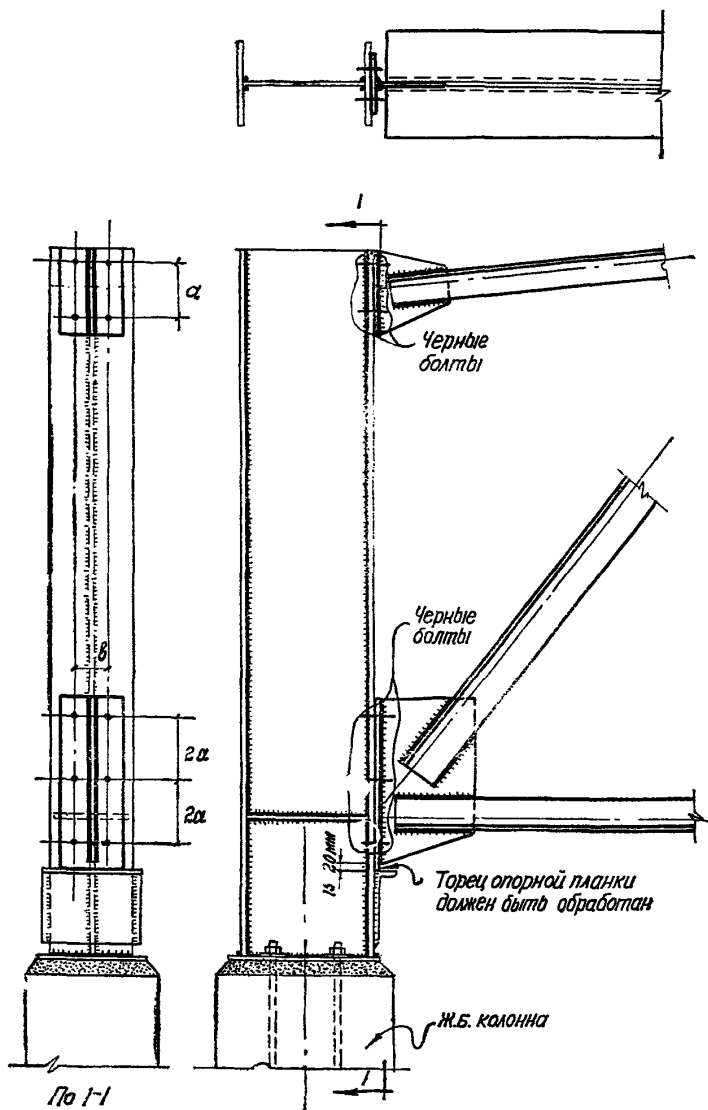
Опираение стропильной фермы на железобетонную колонну при помощи металлического оголовка
